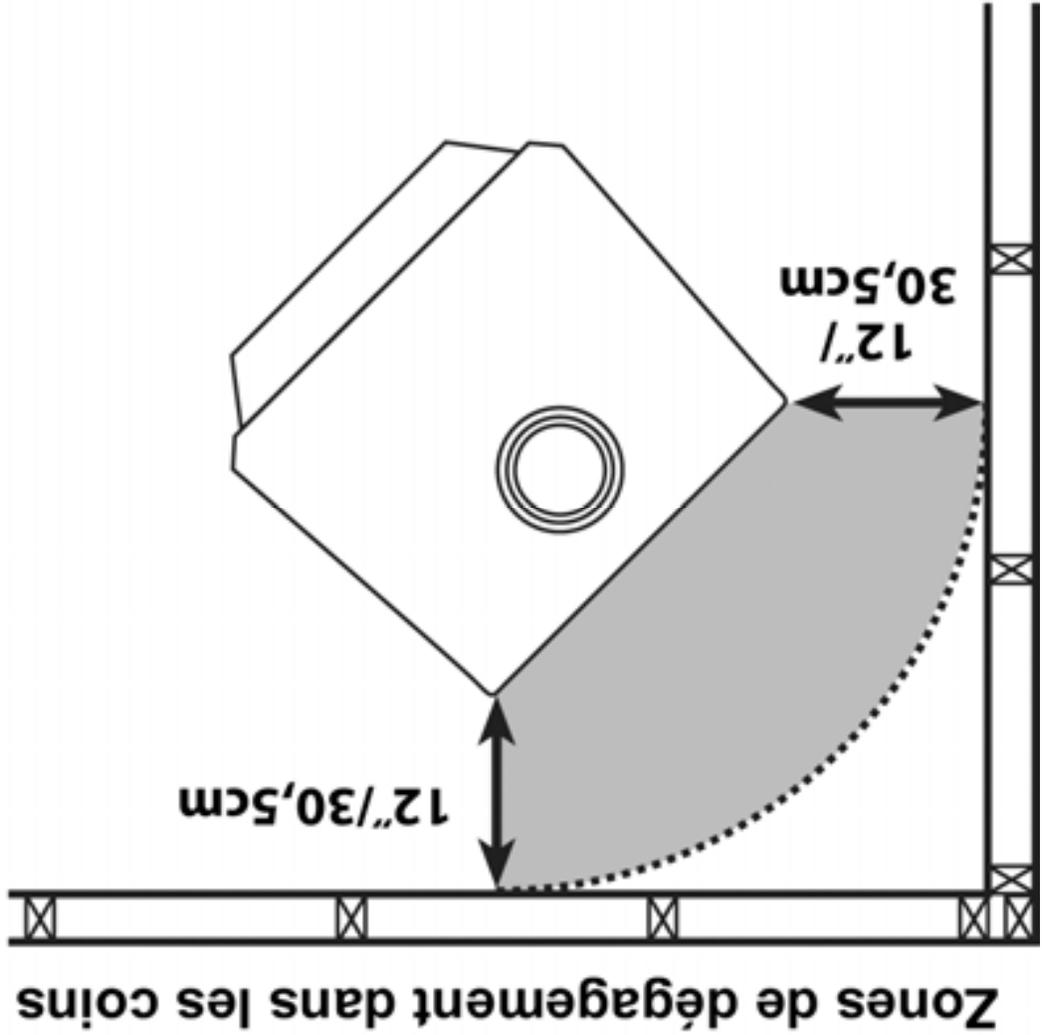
Dimensions minimales des zones de dégagement des surfaces combustibles (É.-U.)
